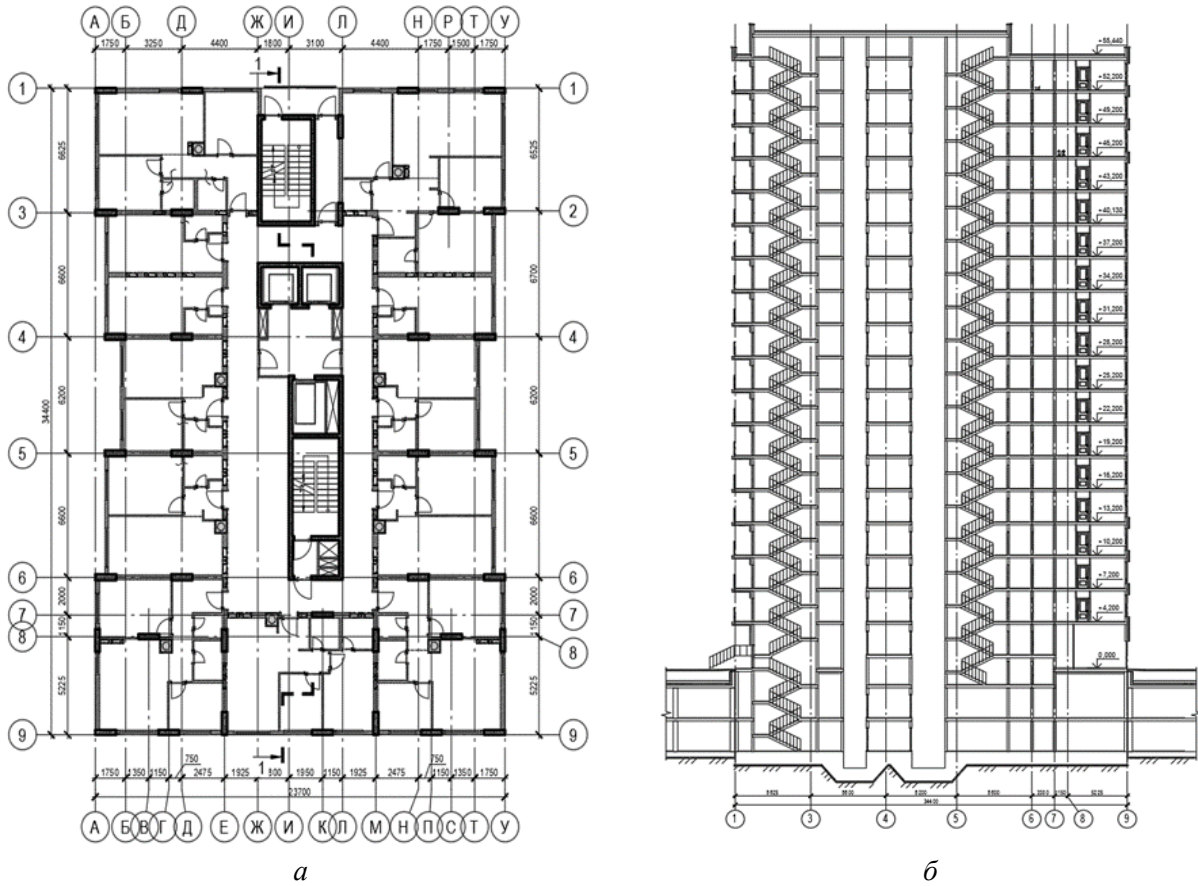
18-ти поверховий житловий будинок у м. Києві. *a* - план типового перекриття; *б* - розріз будинку.
